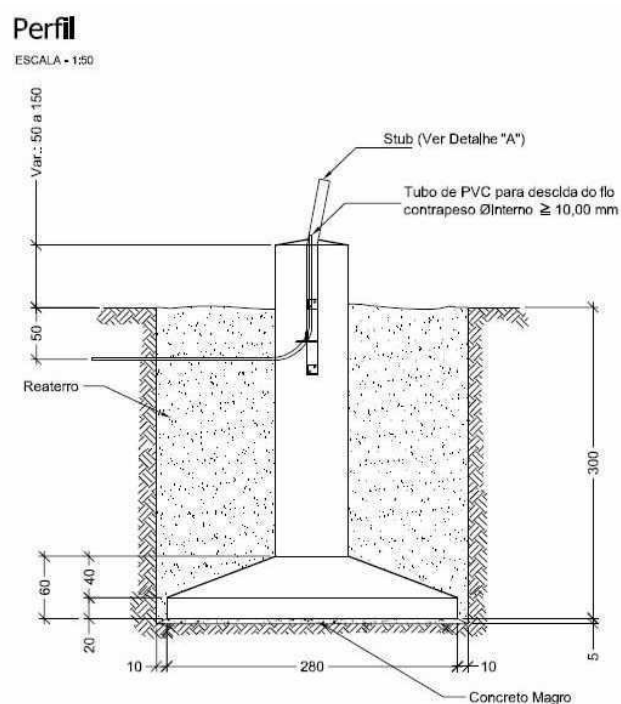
Detalhe da sapata para solo do tipo A de estrutura metálica autoportante A21d (Chesf, 2008).
